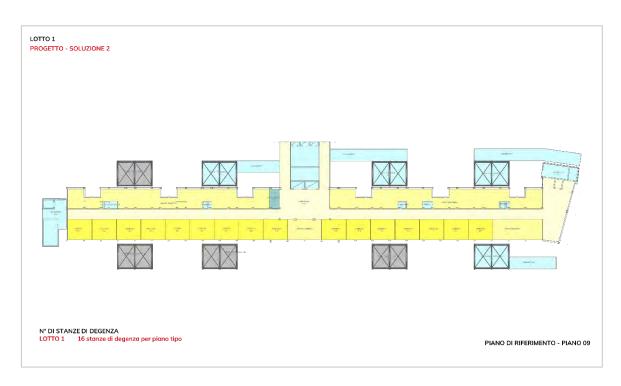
PROGETTO PIANO TIPO LOTTO 1 - SOLUZIONE 2
